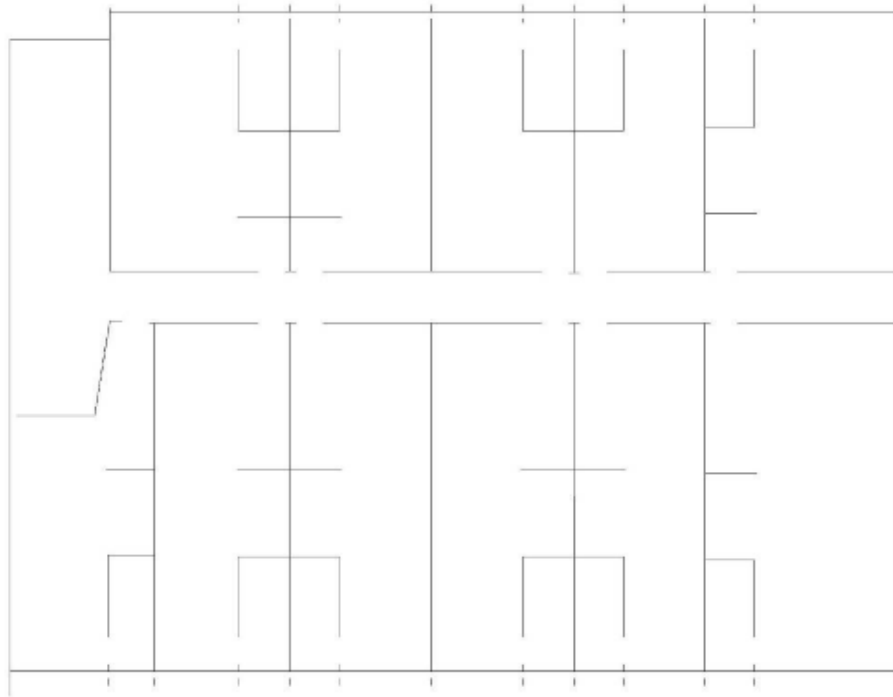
Planta baixa do sexto ao décimo pavimento alterada para linhas
